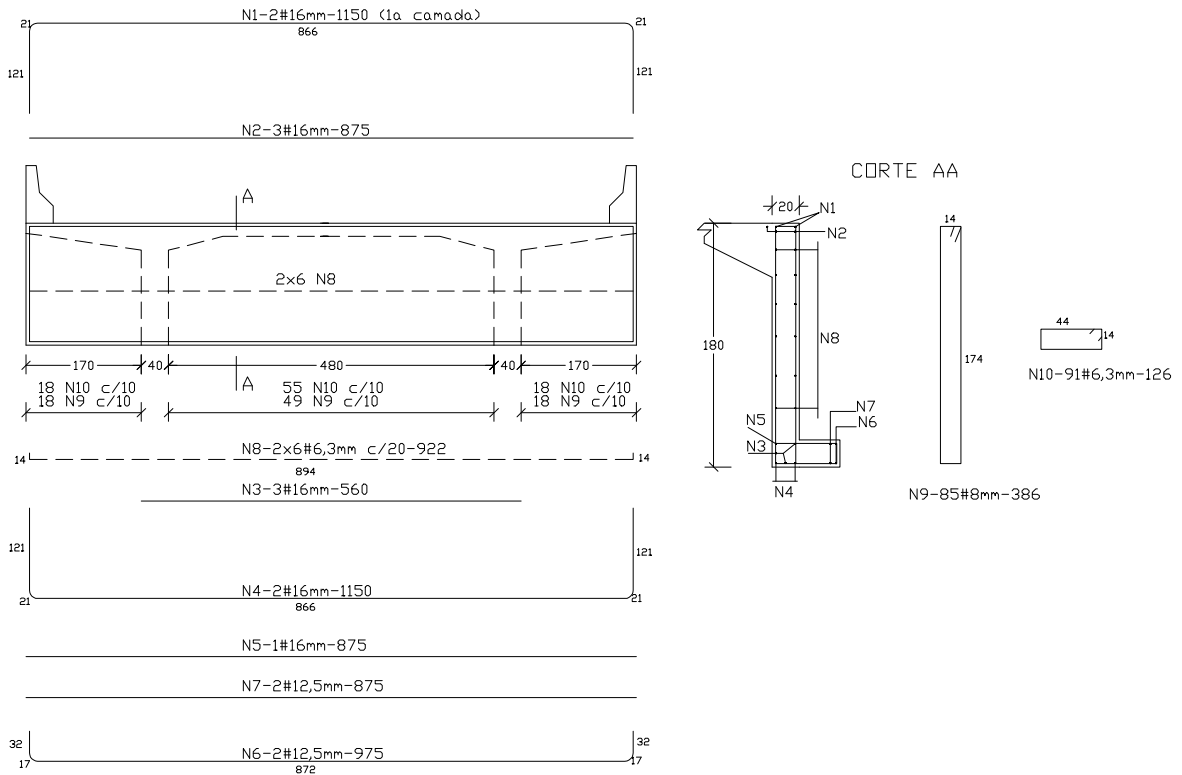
Detalhe da armadura das vigas de fechamento.
